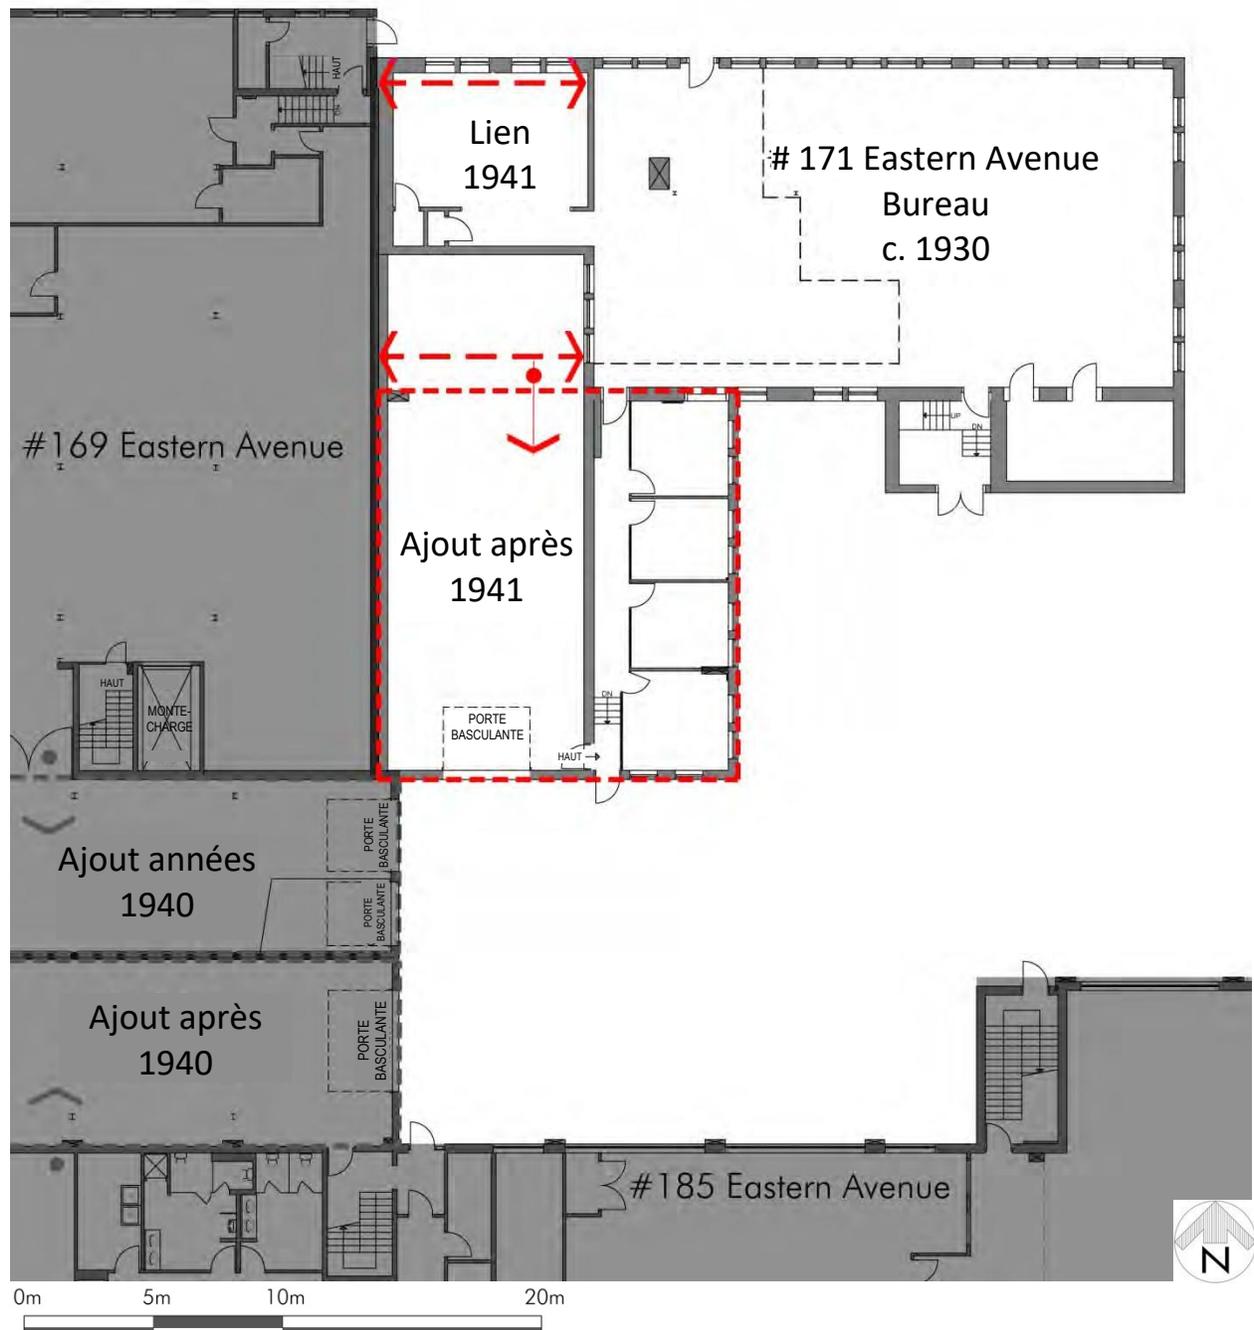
171 avenue Eastern – Plan du rez-de-chaussée des bureaux.
